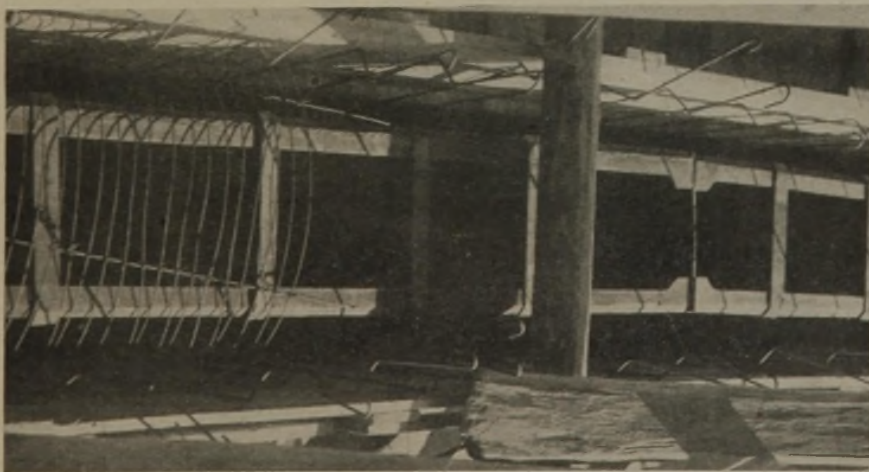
Gußeisenbewehrung vor der Betonierung.
